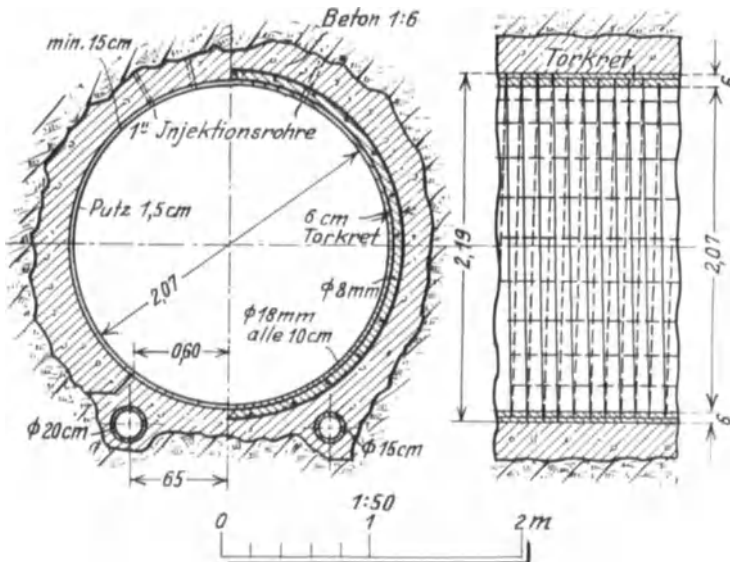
Druckstollenquerschnitte des Strubklammwerks. (Bautechn. 1927.)
